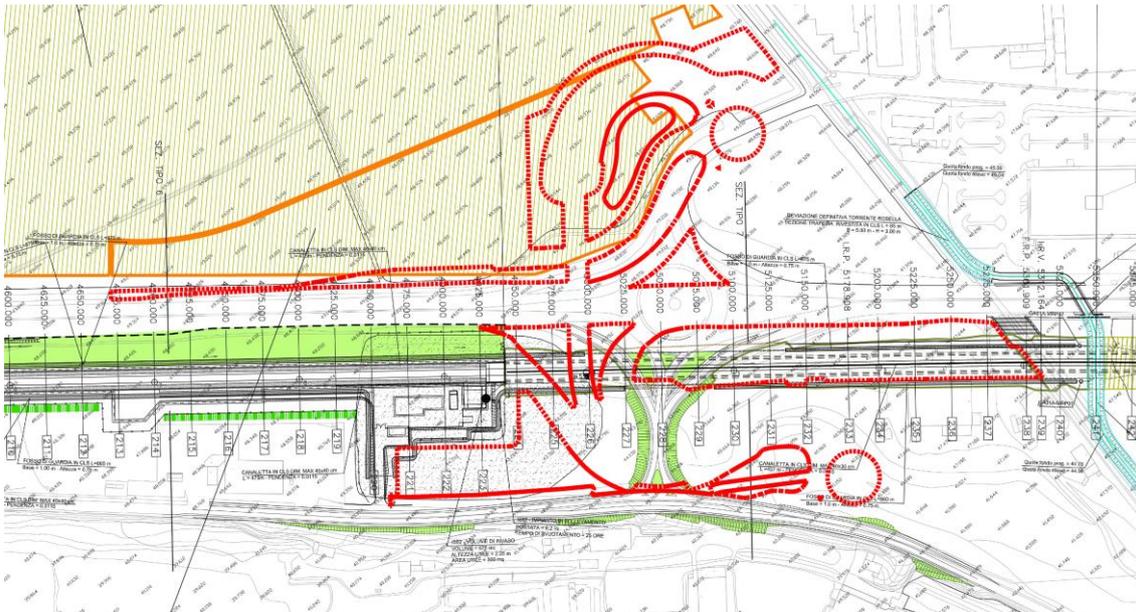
Stralcio Planimetria di PD – in rosso i perimetri delle nuove aree di intervento di PE
